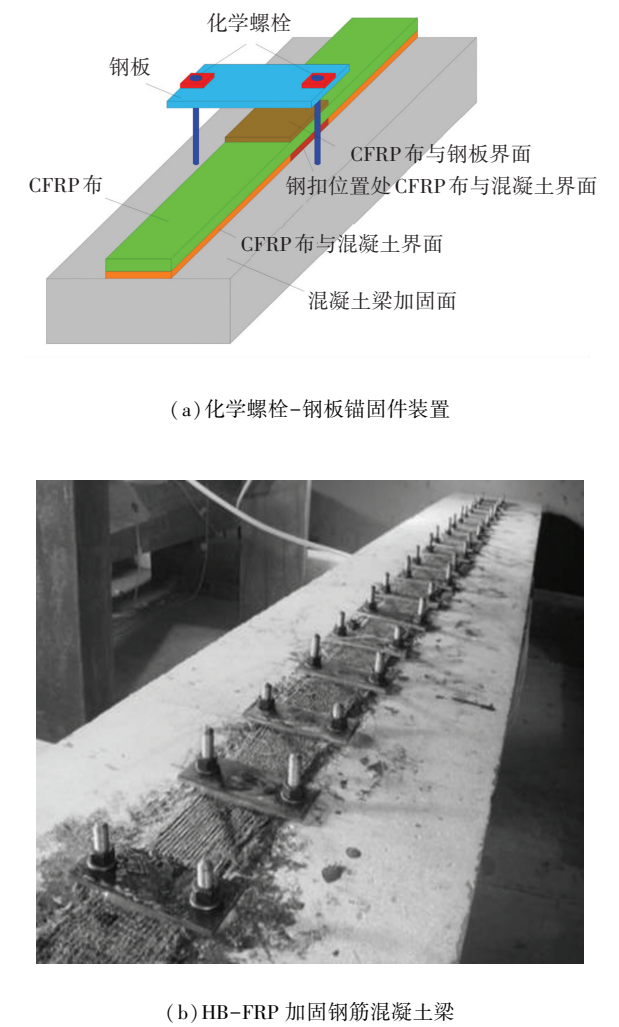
化学螺栓-钢板锚固件和 HB-FRP 抗弯加固钢筋混凝土梁
